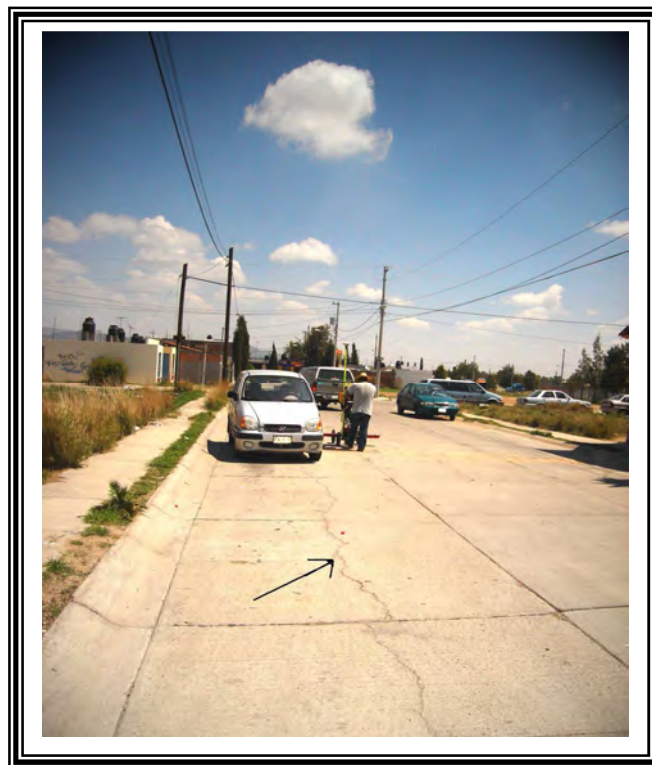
Estructuras civiles afectadas por la falla en la calle Bonampank
